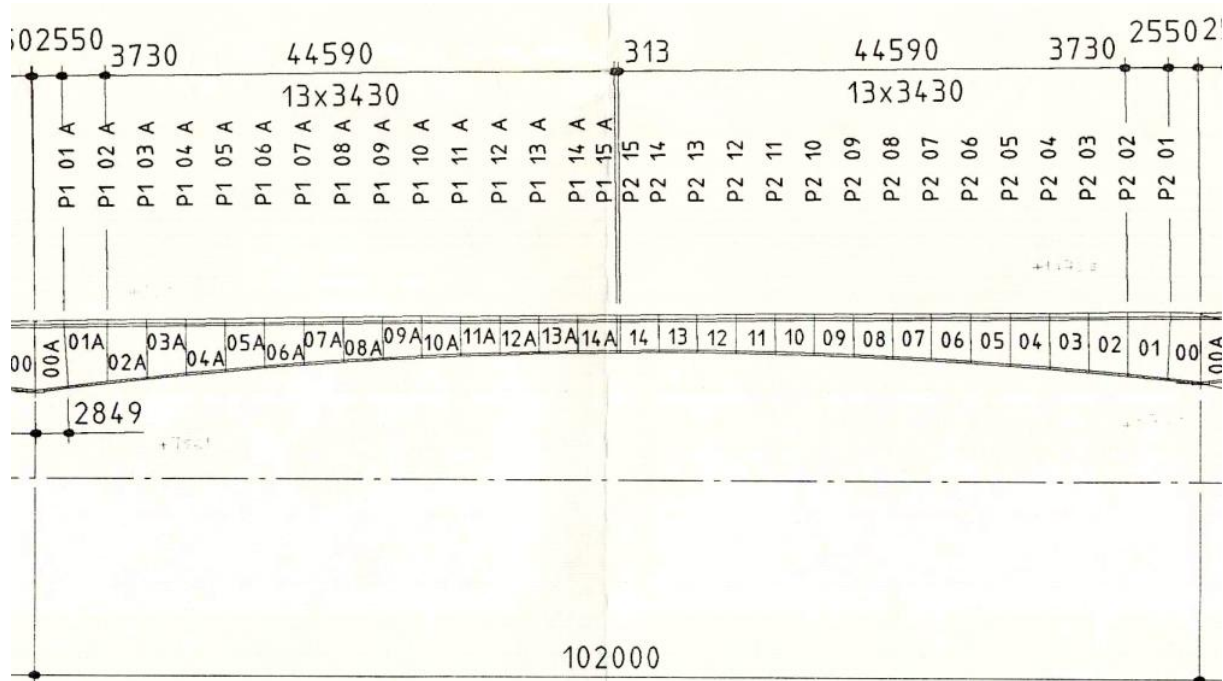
Vue longitudinale d'une travée courante (T2 à T6) (extrait plan P402)
